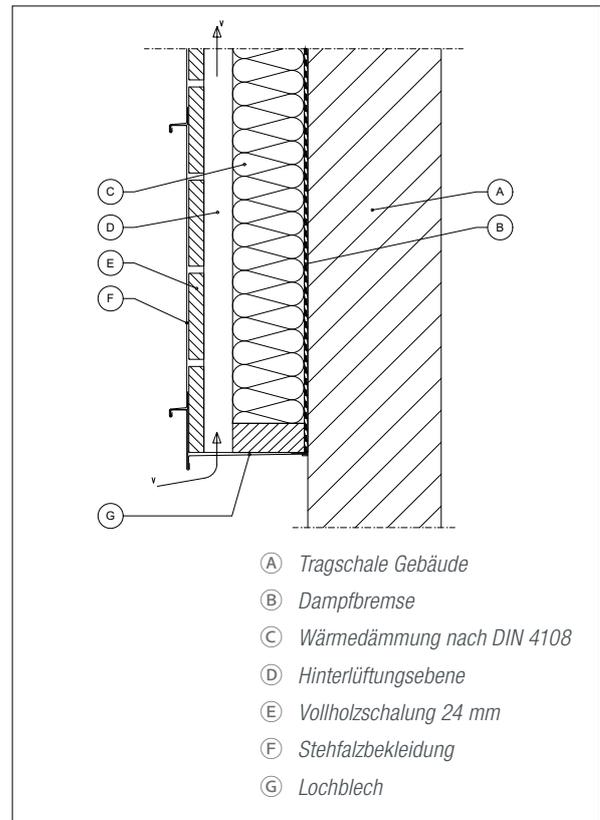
Winkelstehfalz horizontal Fassadenanschluss unten
